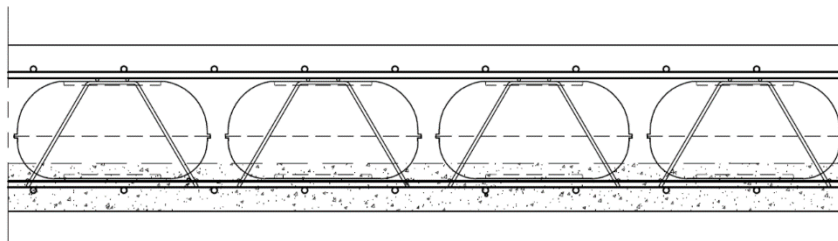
Seção tipo da laje aligeirada (Ferca, 2011)
